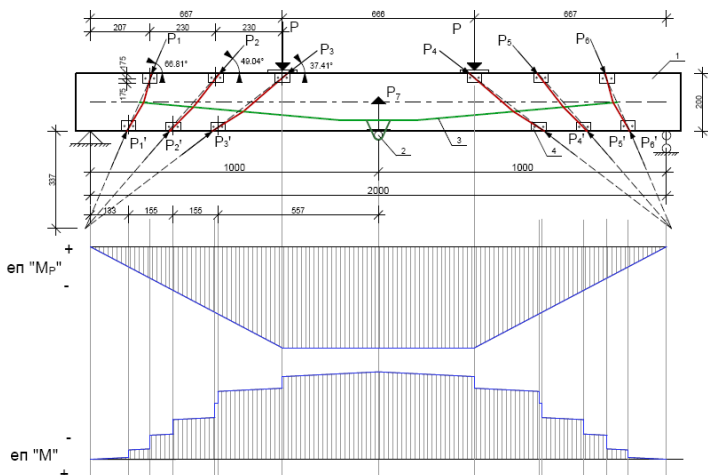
Регульовано напружена залізобетонна балка (варіант №2):
